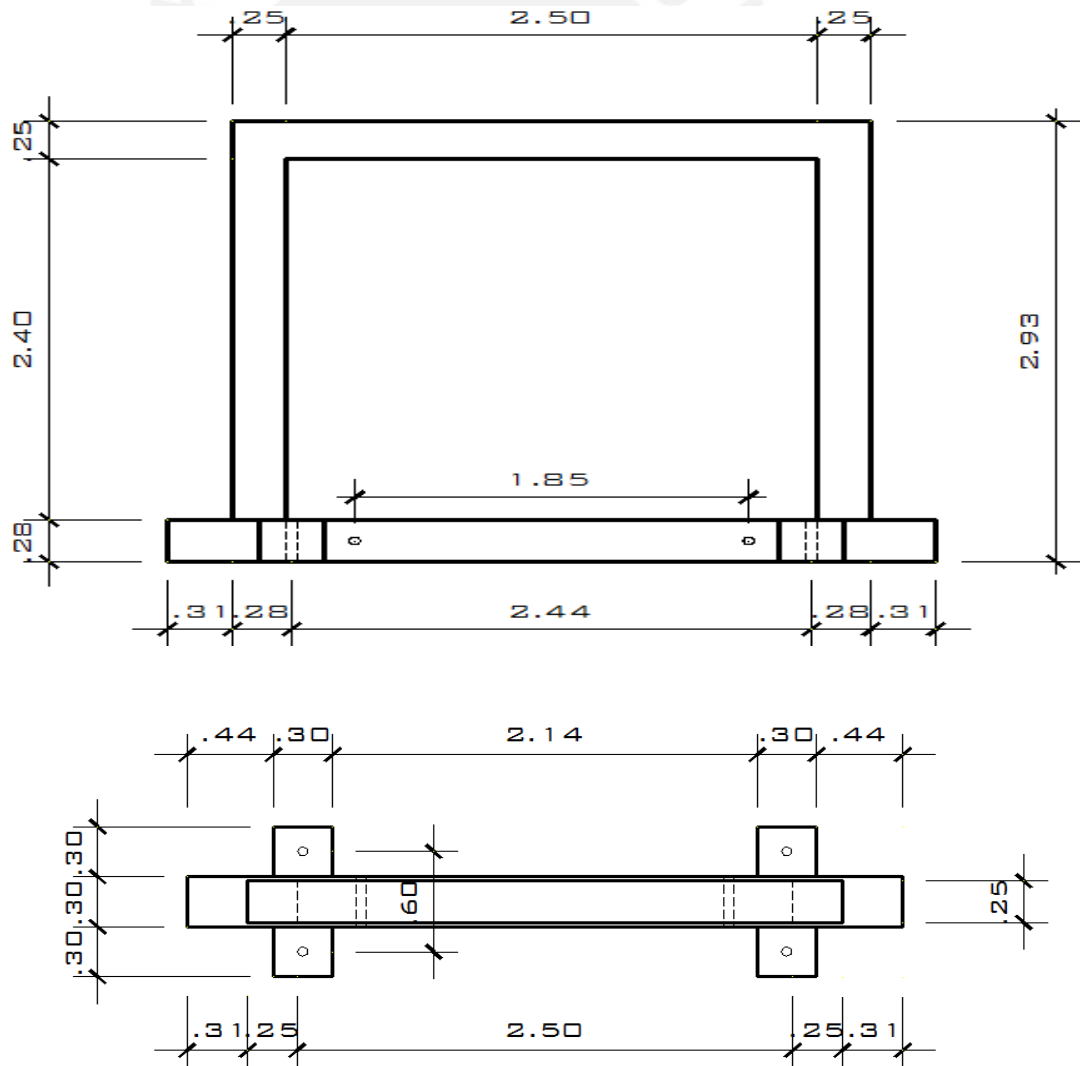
Dimensiones del Pórtico de Concreto Armado – Elevación y planta.
